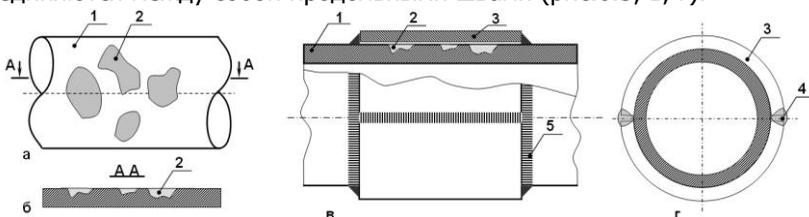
Ремонт поврежденного участка трубопровода с применением муфт: 1 – труба; 2 – коррозионные повреждения; 3 – полуцилиндры муфты; 4 – сварные швы, соединяющие полуцилиндры между собой; 5 – швы, присоединяющие торцы муфты к трубе
